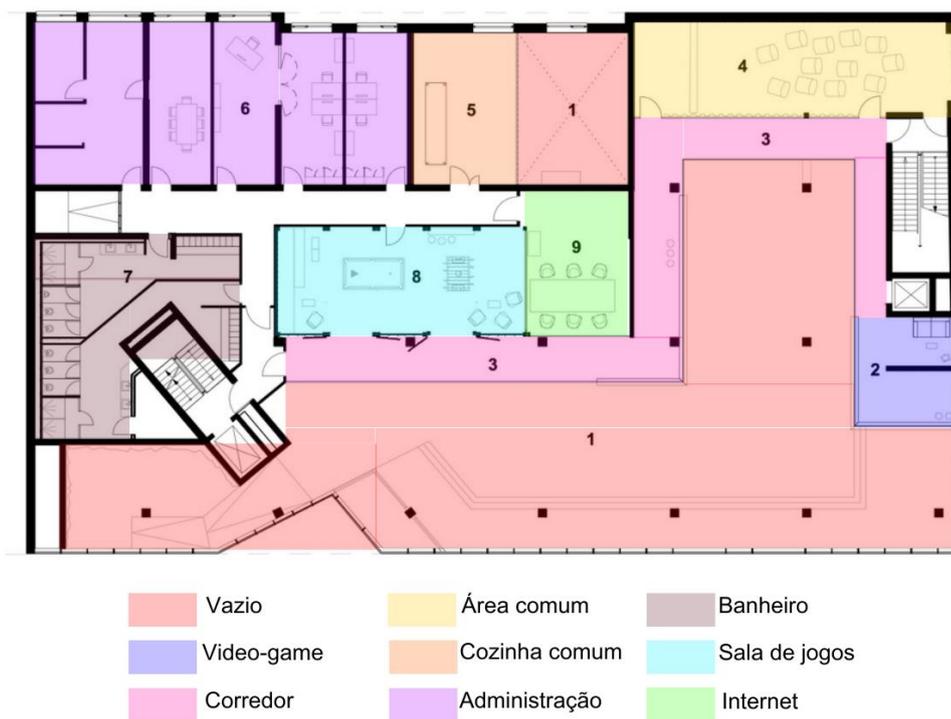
Setorização / Planta baixa 1º Pav. Alterado pelo autor.
